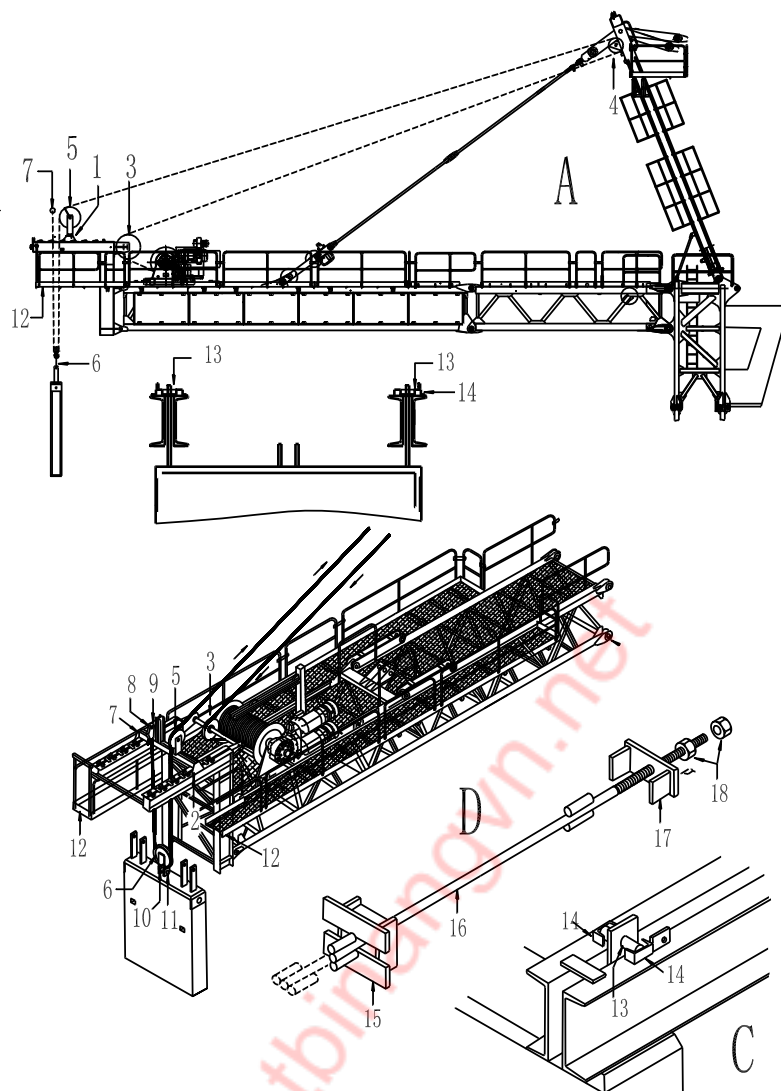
安装配重 Fig. 4-41 Ballasting installation
